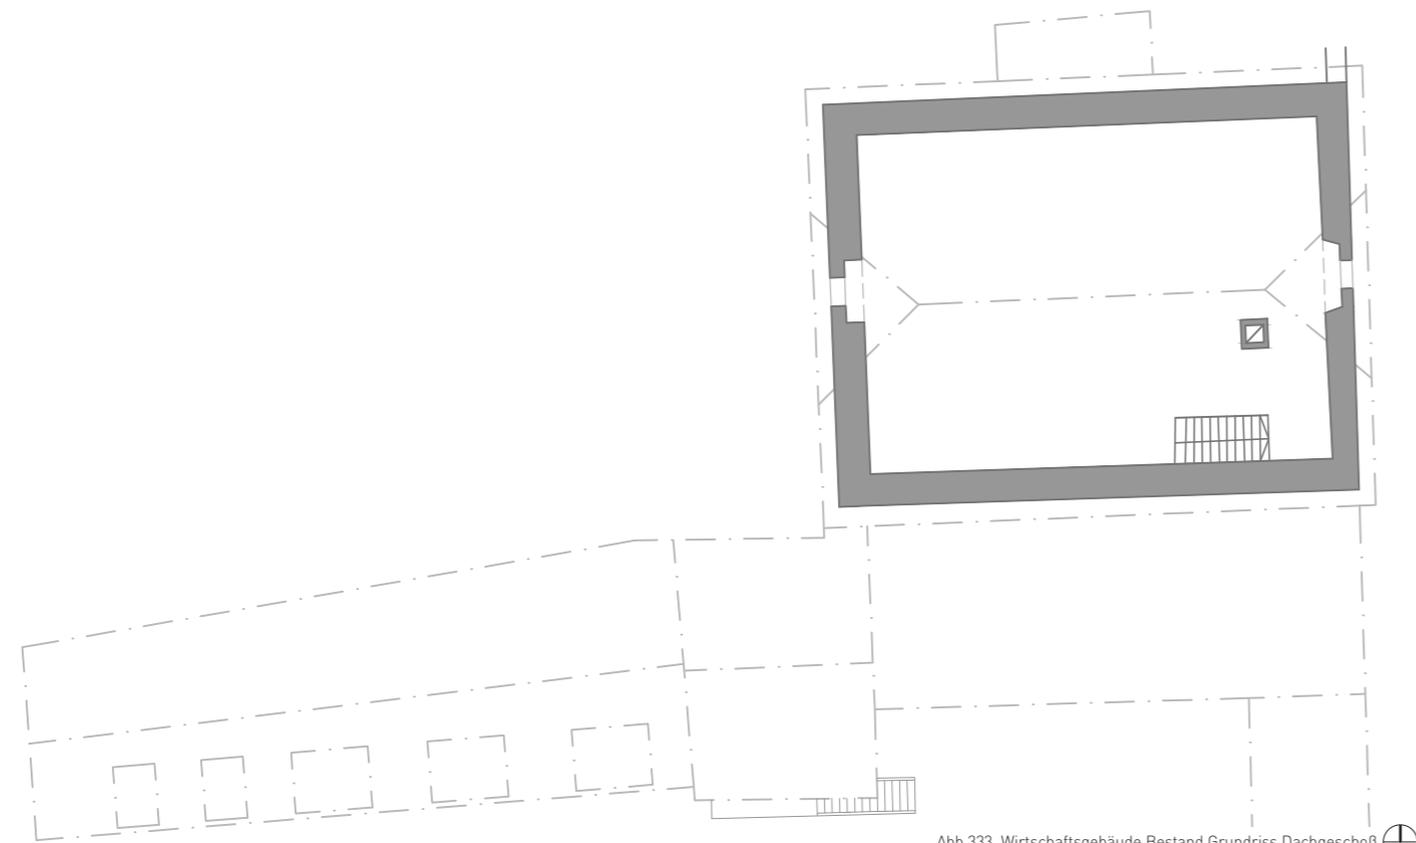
Wirtschaftsgebäude Bestand Grundriss Dachgeschoß ⊕
